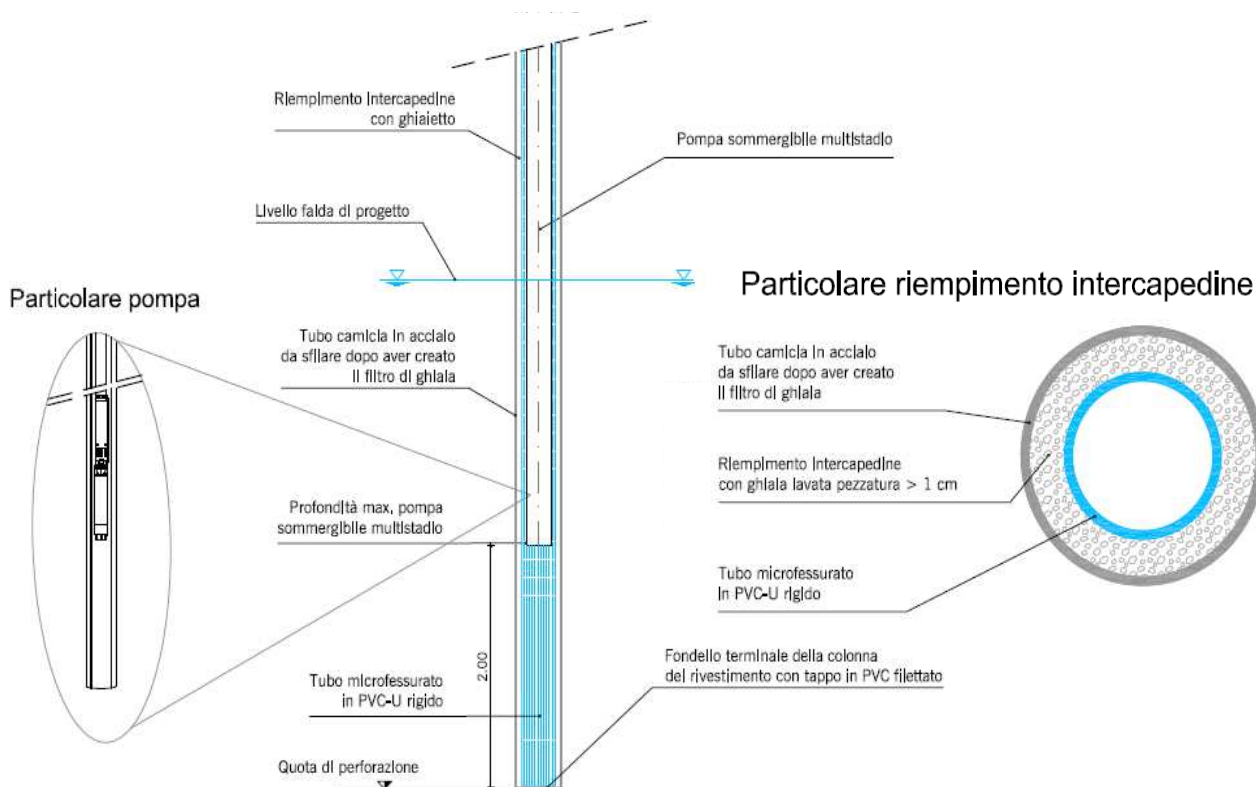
Sezione tipo del pozzo e particolare riempimento dell'intercapedine.
